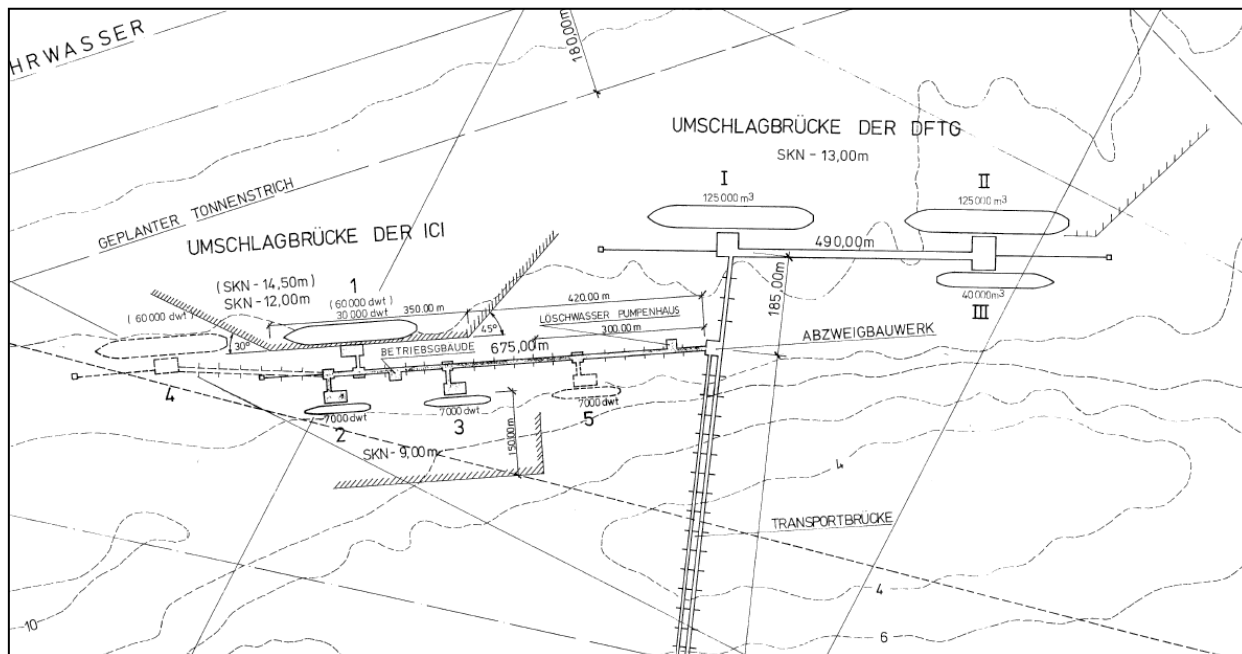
Planausschnitt Planunterlage zum Planfeststellungsbeschluss vom 29.03.1979
